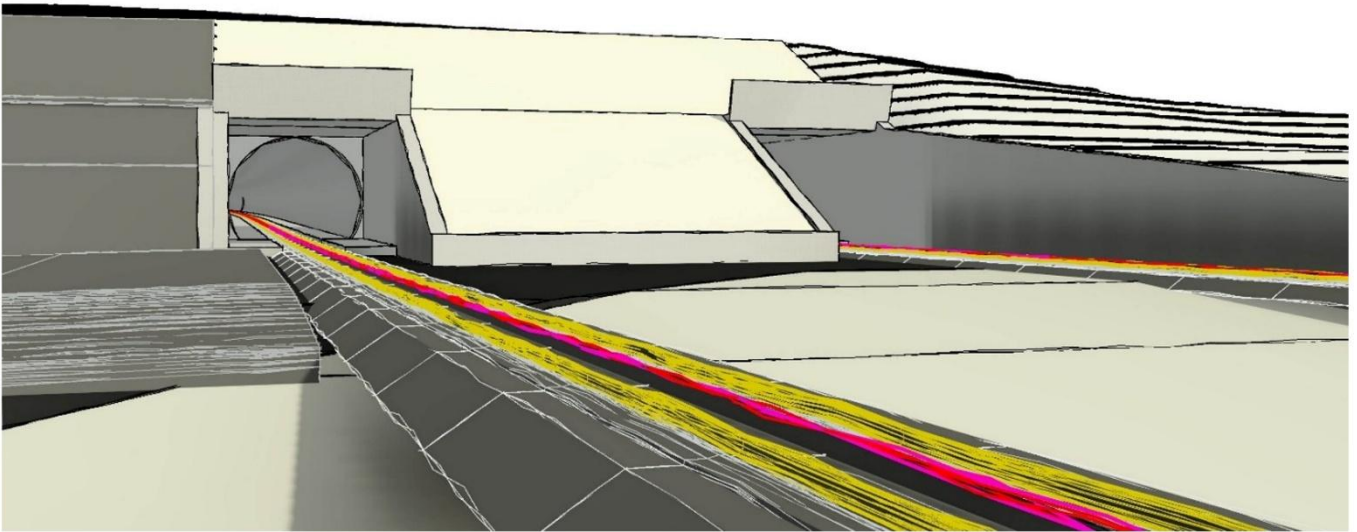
Visualization of the Střížkov Tunnel portal at Balabenka (architect Pavel Sýs)
